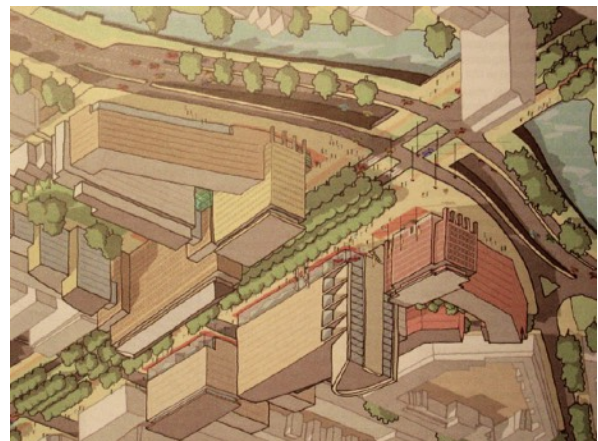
en 238 LINKS Voorstel ombouw stedelijke stroomweg van 2 x 2 stroken tot boulevard van 2 x 1 strook (Vgl. LARGAS geïnspireerde 'Down-Grading'); vrijgekomen profielbreedte inzetten voor activiteiten langs de gevel en 2 centrale rijen bomen: Wibautstraat te Amsterdam. RECHTS '3-D' schets van een ombouw van een stedelijke stroomweg tot boulevard, ter informatie voor inspraak en bestuur over nieuwe ruimtelijke betekenis.
